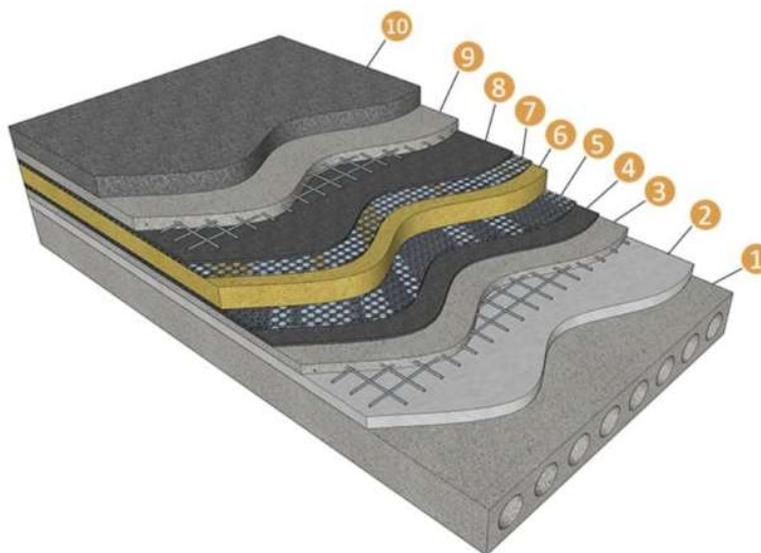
Автомобильная зона эксплуатируемой крыши: 1 — плита перекрытия; 2 — уклонообразующая стяжка; 3 — цементно-песчаная армированная стяжка; 4 — гидроизоляция; 5 — дренирующий слой; 6 — утеплитель; 7 — дренирующий слой; 8 — гидроизоляция; 9 — цементно-песчаная армированная стяжка; 10 — асфальтобетон.
